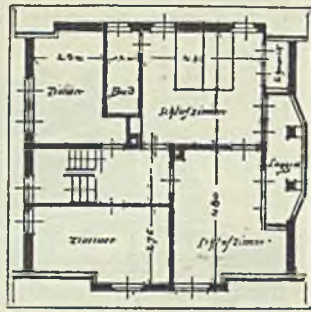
Beamtenhaus für Delmenhorst. Architekt D. Bollmann, Bremen
